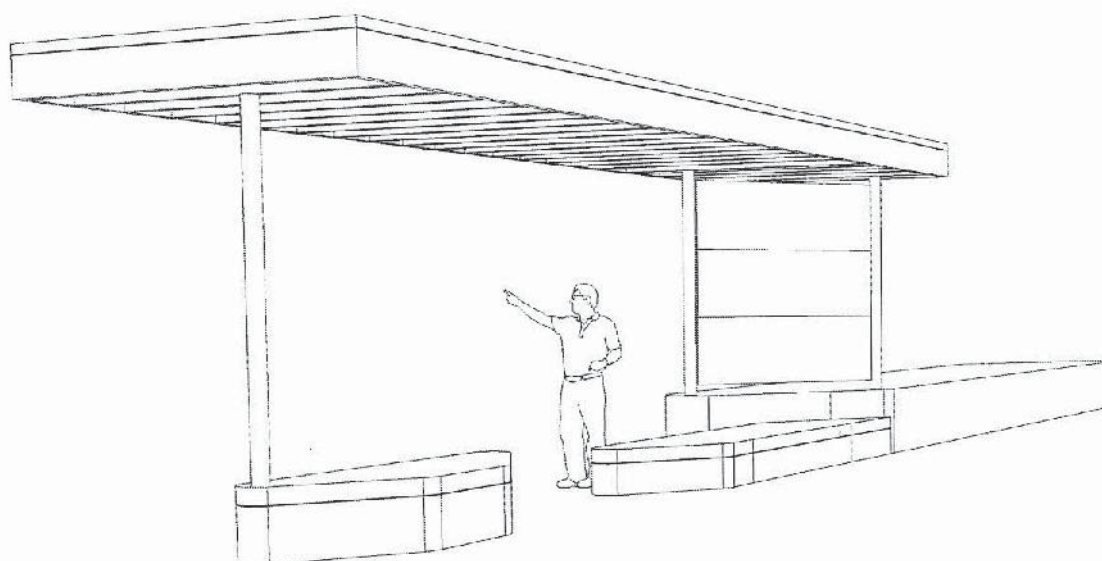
CROQUIS DE APEADERO DE COLECTIVOS
